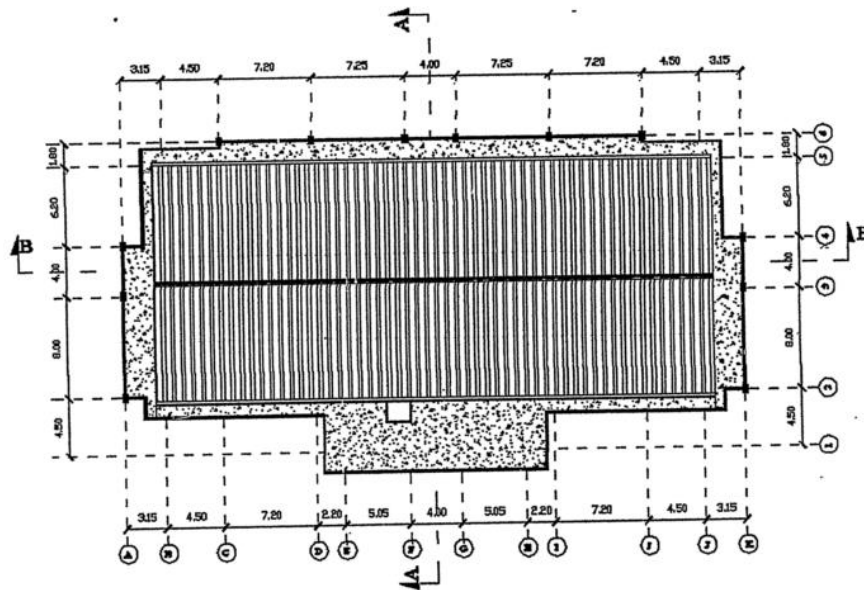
Gambar Denah Lantai Dasar Bangunan
